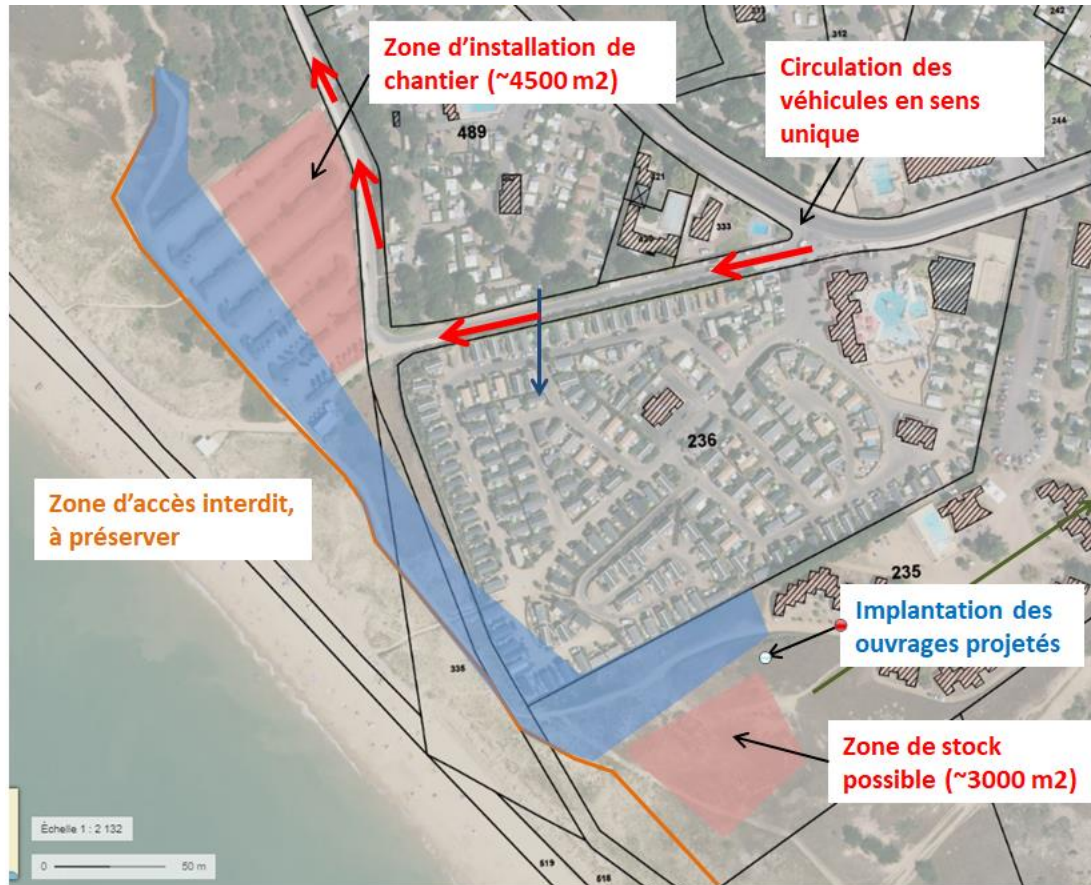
Plan des installations de chantier, accès et zone de stockage
